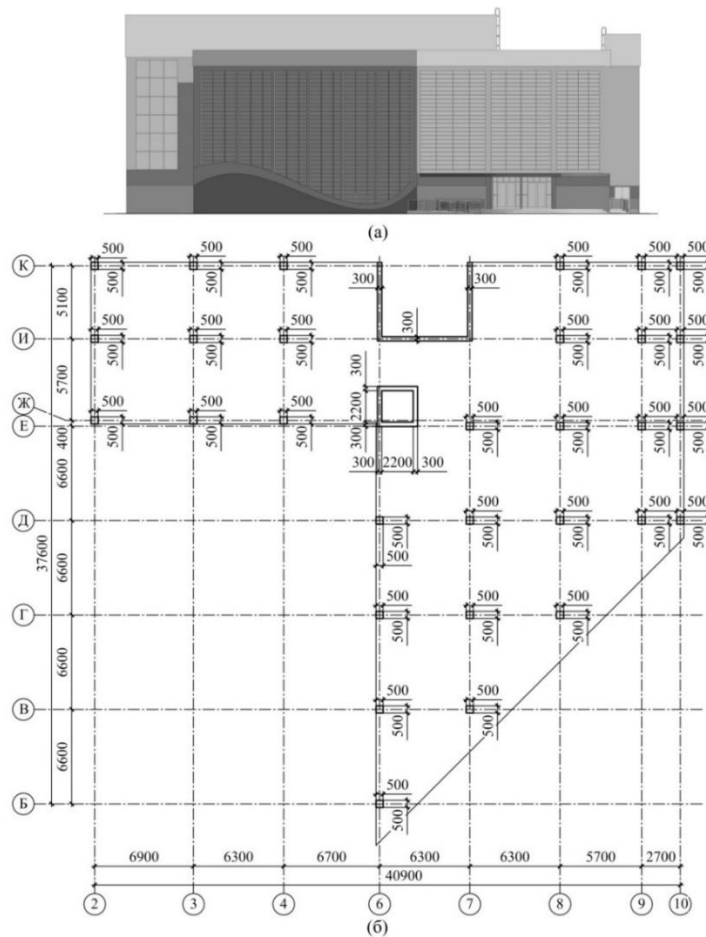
Проектируемое здание аквапарка: а) фасад; б) план расположения несущих конструкций
